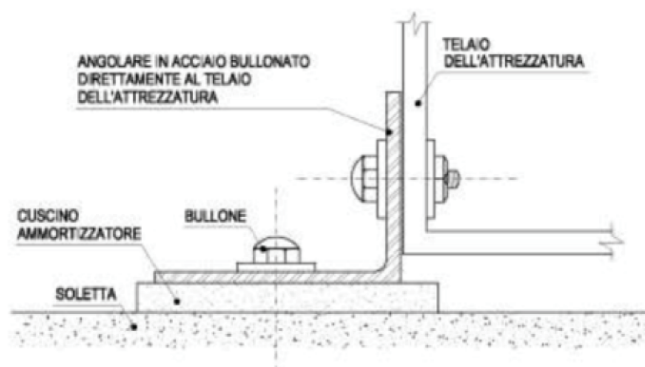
esempio di ancoraggio di apparecchiatura alla soletta/pavimento
